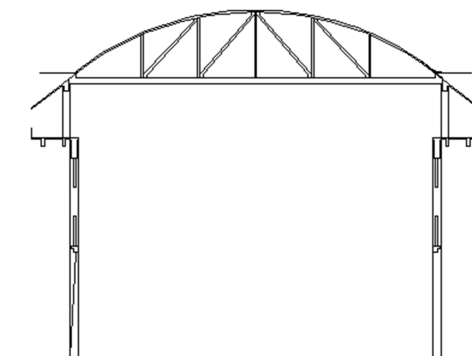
coupe sur le hall de stockage, source : La cimenterie de Rais Hamidou
